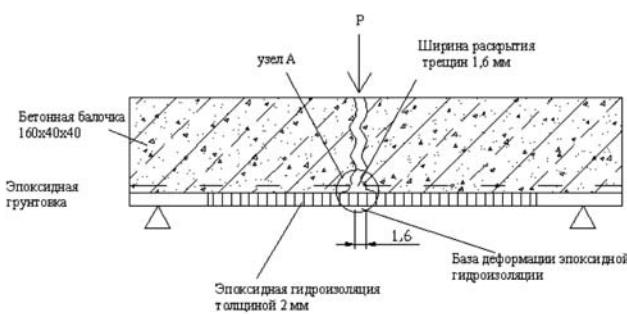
Схема испытания эпоксидного гидроизоляционного покрытия в зоне образования трещины
